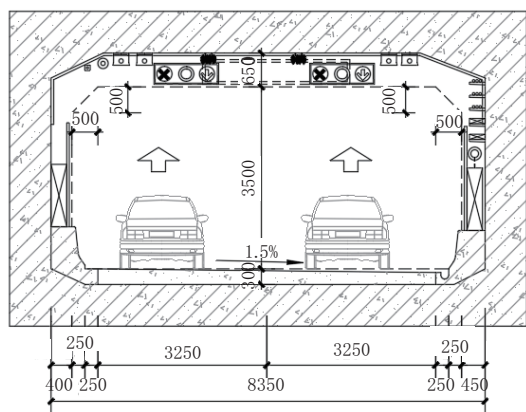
匝道 Z3、Z4 和 Z5 横断面图(单位:mm)
